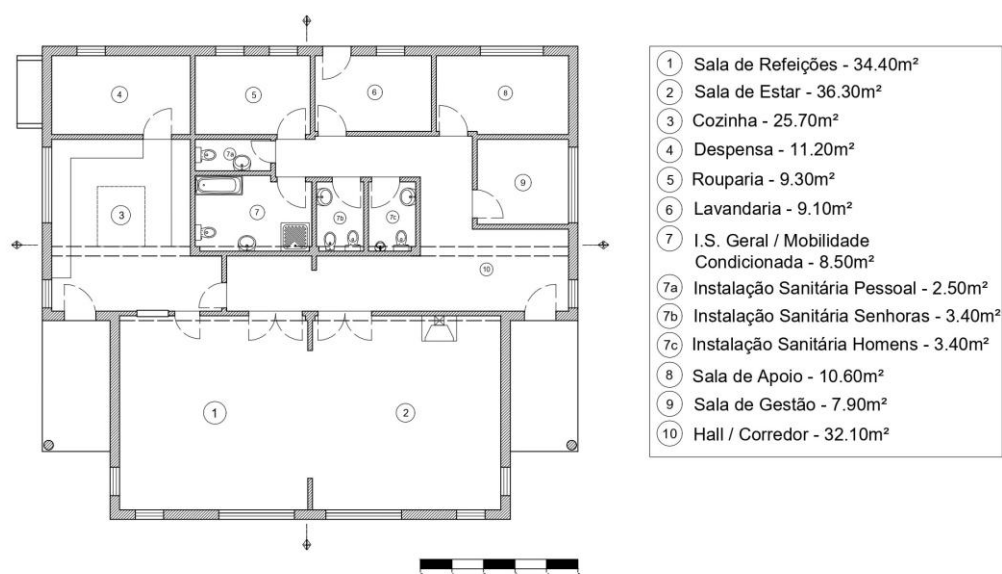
Planta de Levantamento. Fonte: Pires, A. (Fevereiro 2026)
